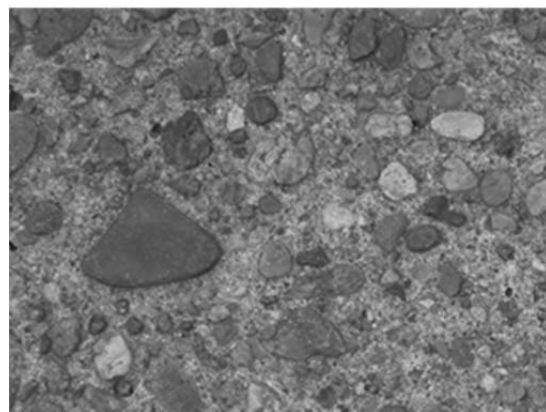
双川橋の路面の状況 (拡大) (2014.8)
